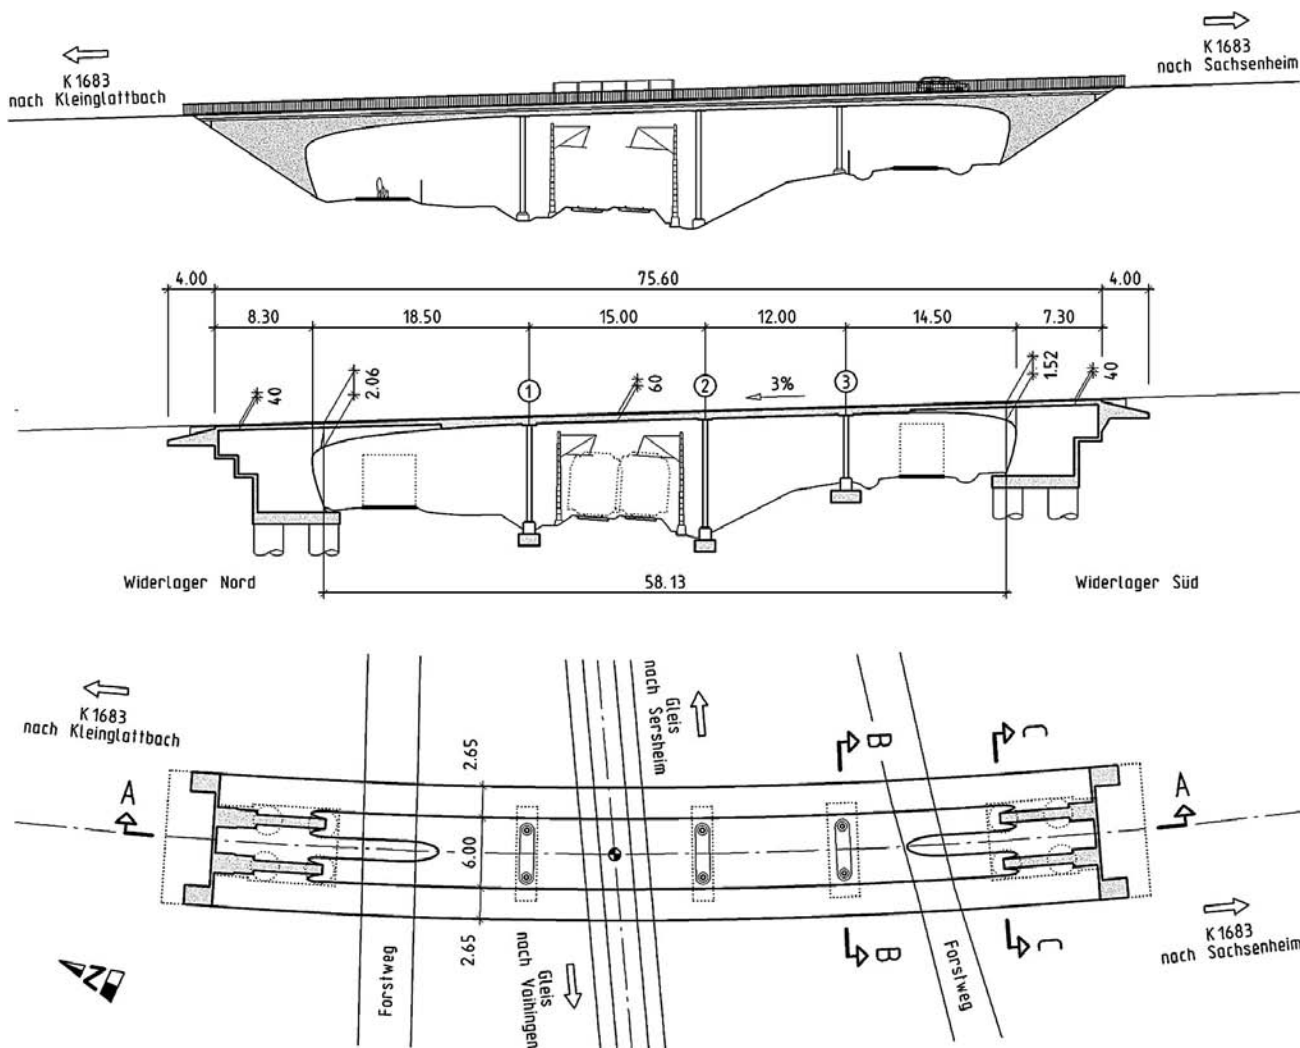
Bauwerk 2, Sersheim: Längsansicht, Längsschnitt A-A und Grundriß
